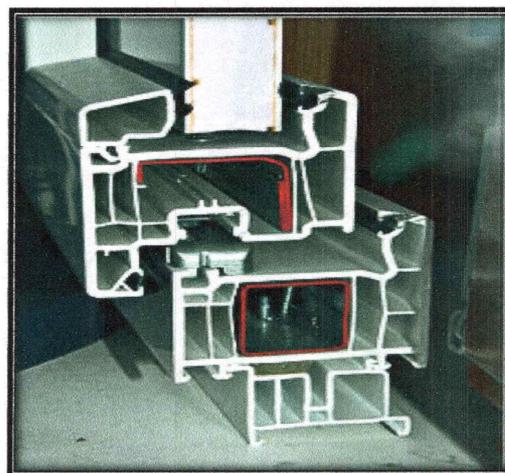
Coupe d'un cadre de Fenêtre en PVC
